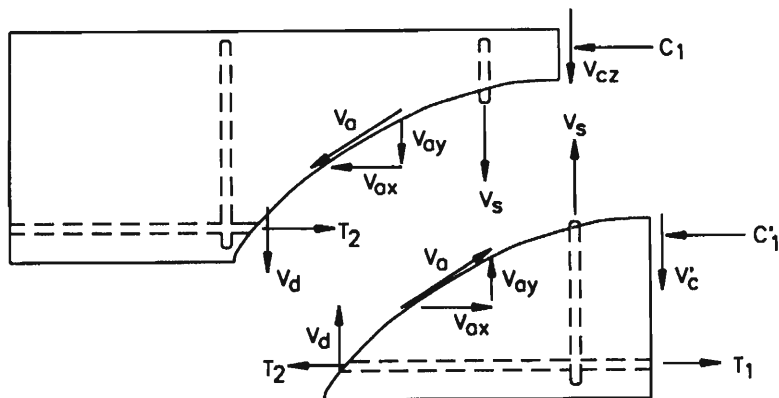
Fuerzas que resisten el corte en vigas con refuerzo en el alma
